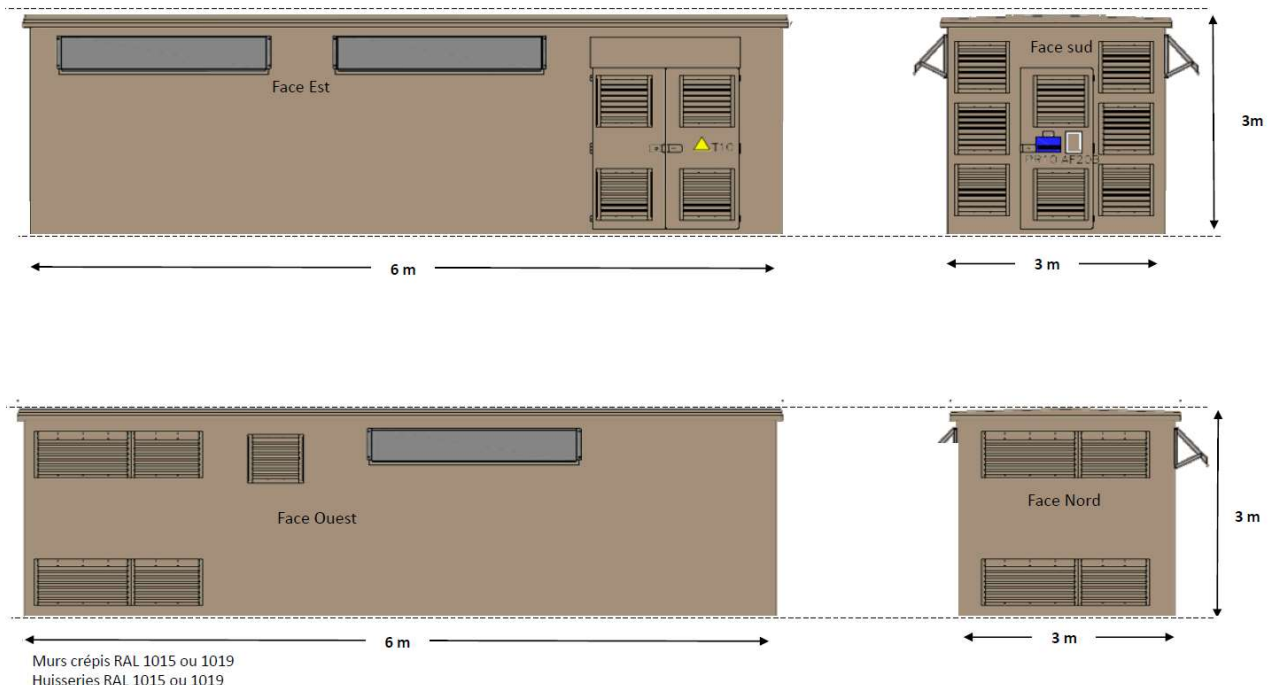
Plan de coupe du terrain, des façades, des tables et du poste électrique
